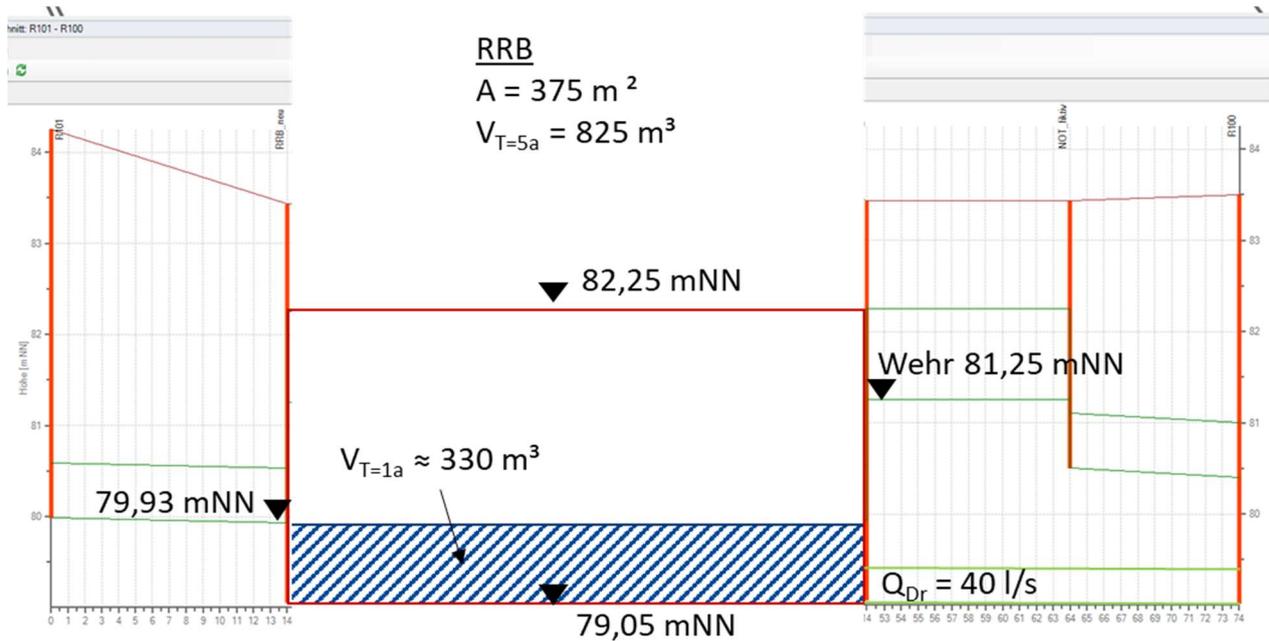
Geplantes RRB – Selbstentleerung Kanalnetz
